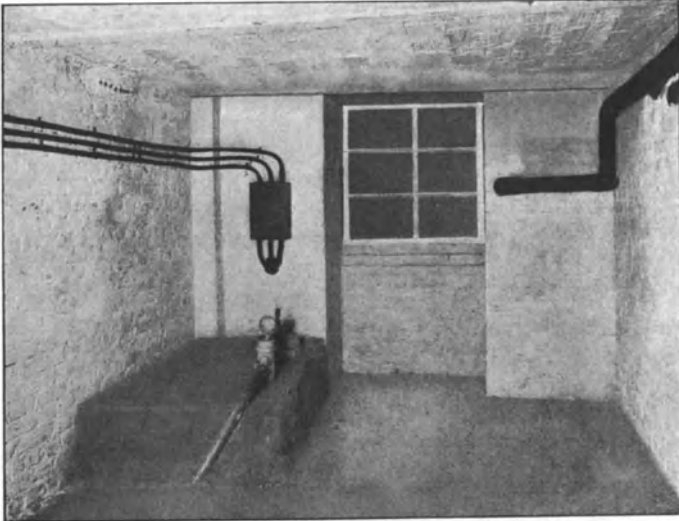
Kellerraum mit den Hausanschlüssen für Elektrizität, Gas und Wasser.
